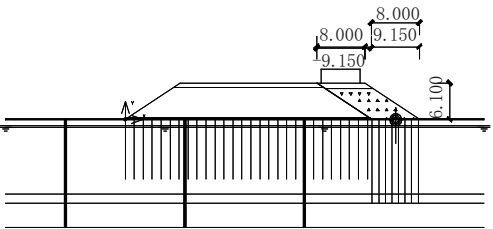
水泥搅拌桩+泡沫混凝土换填计算模型(单位:m)
